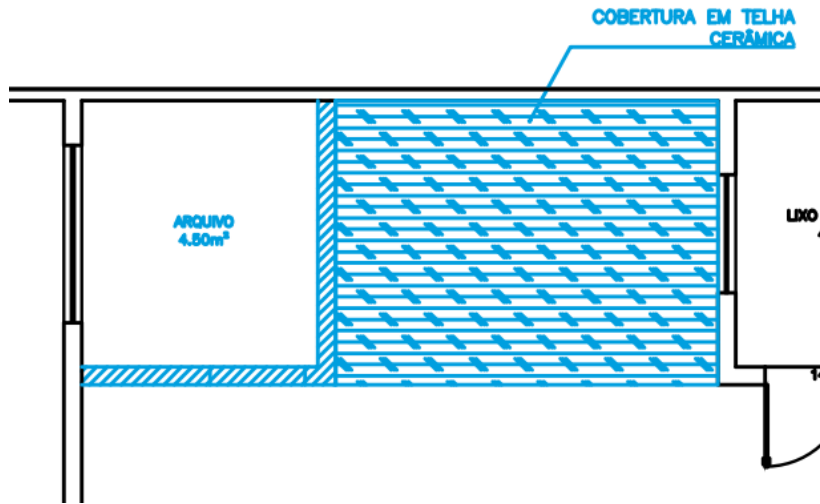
Trecho do projeto com indicação de construção para área de arquivo
